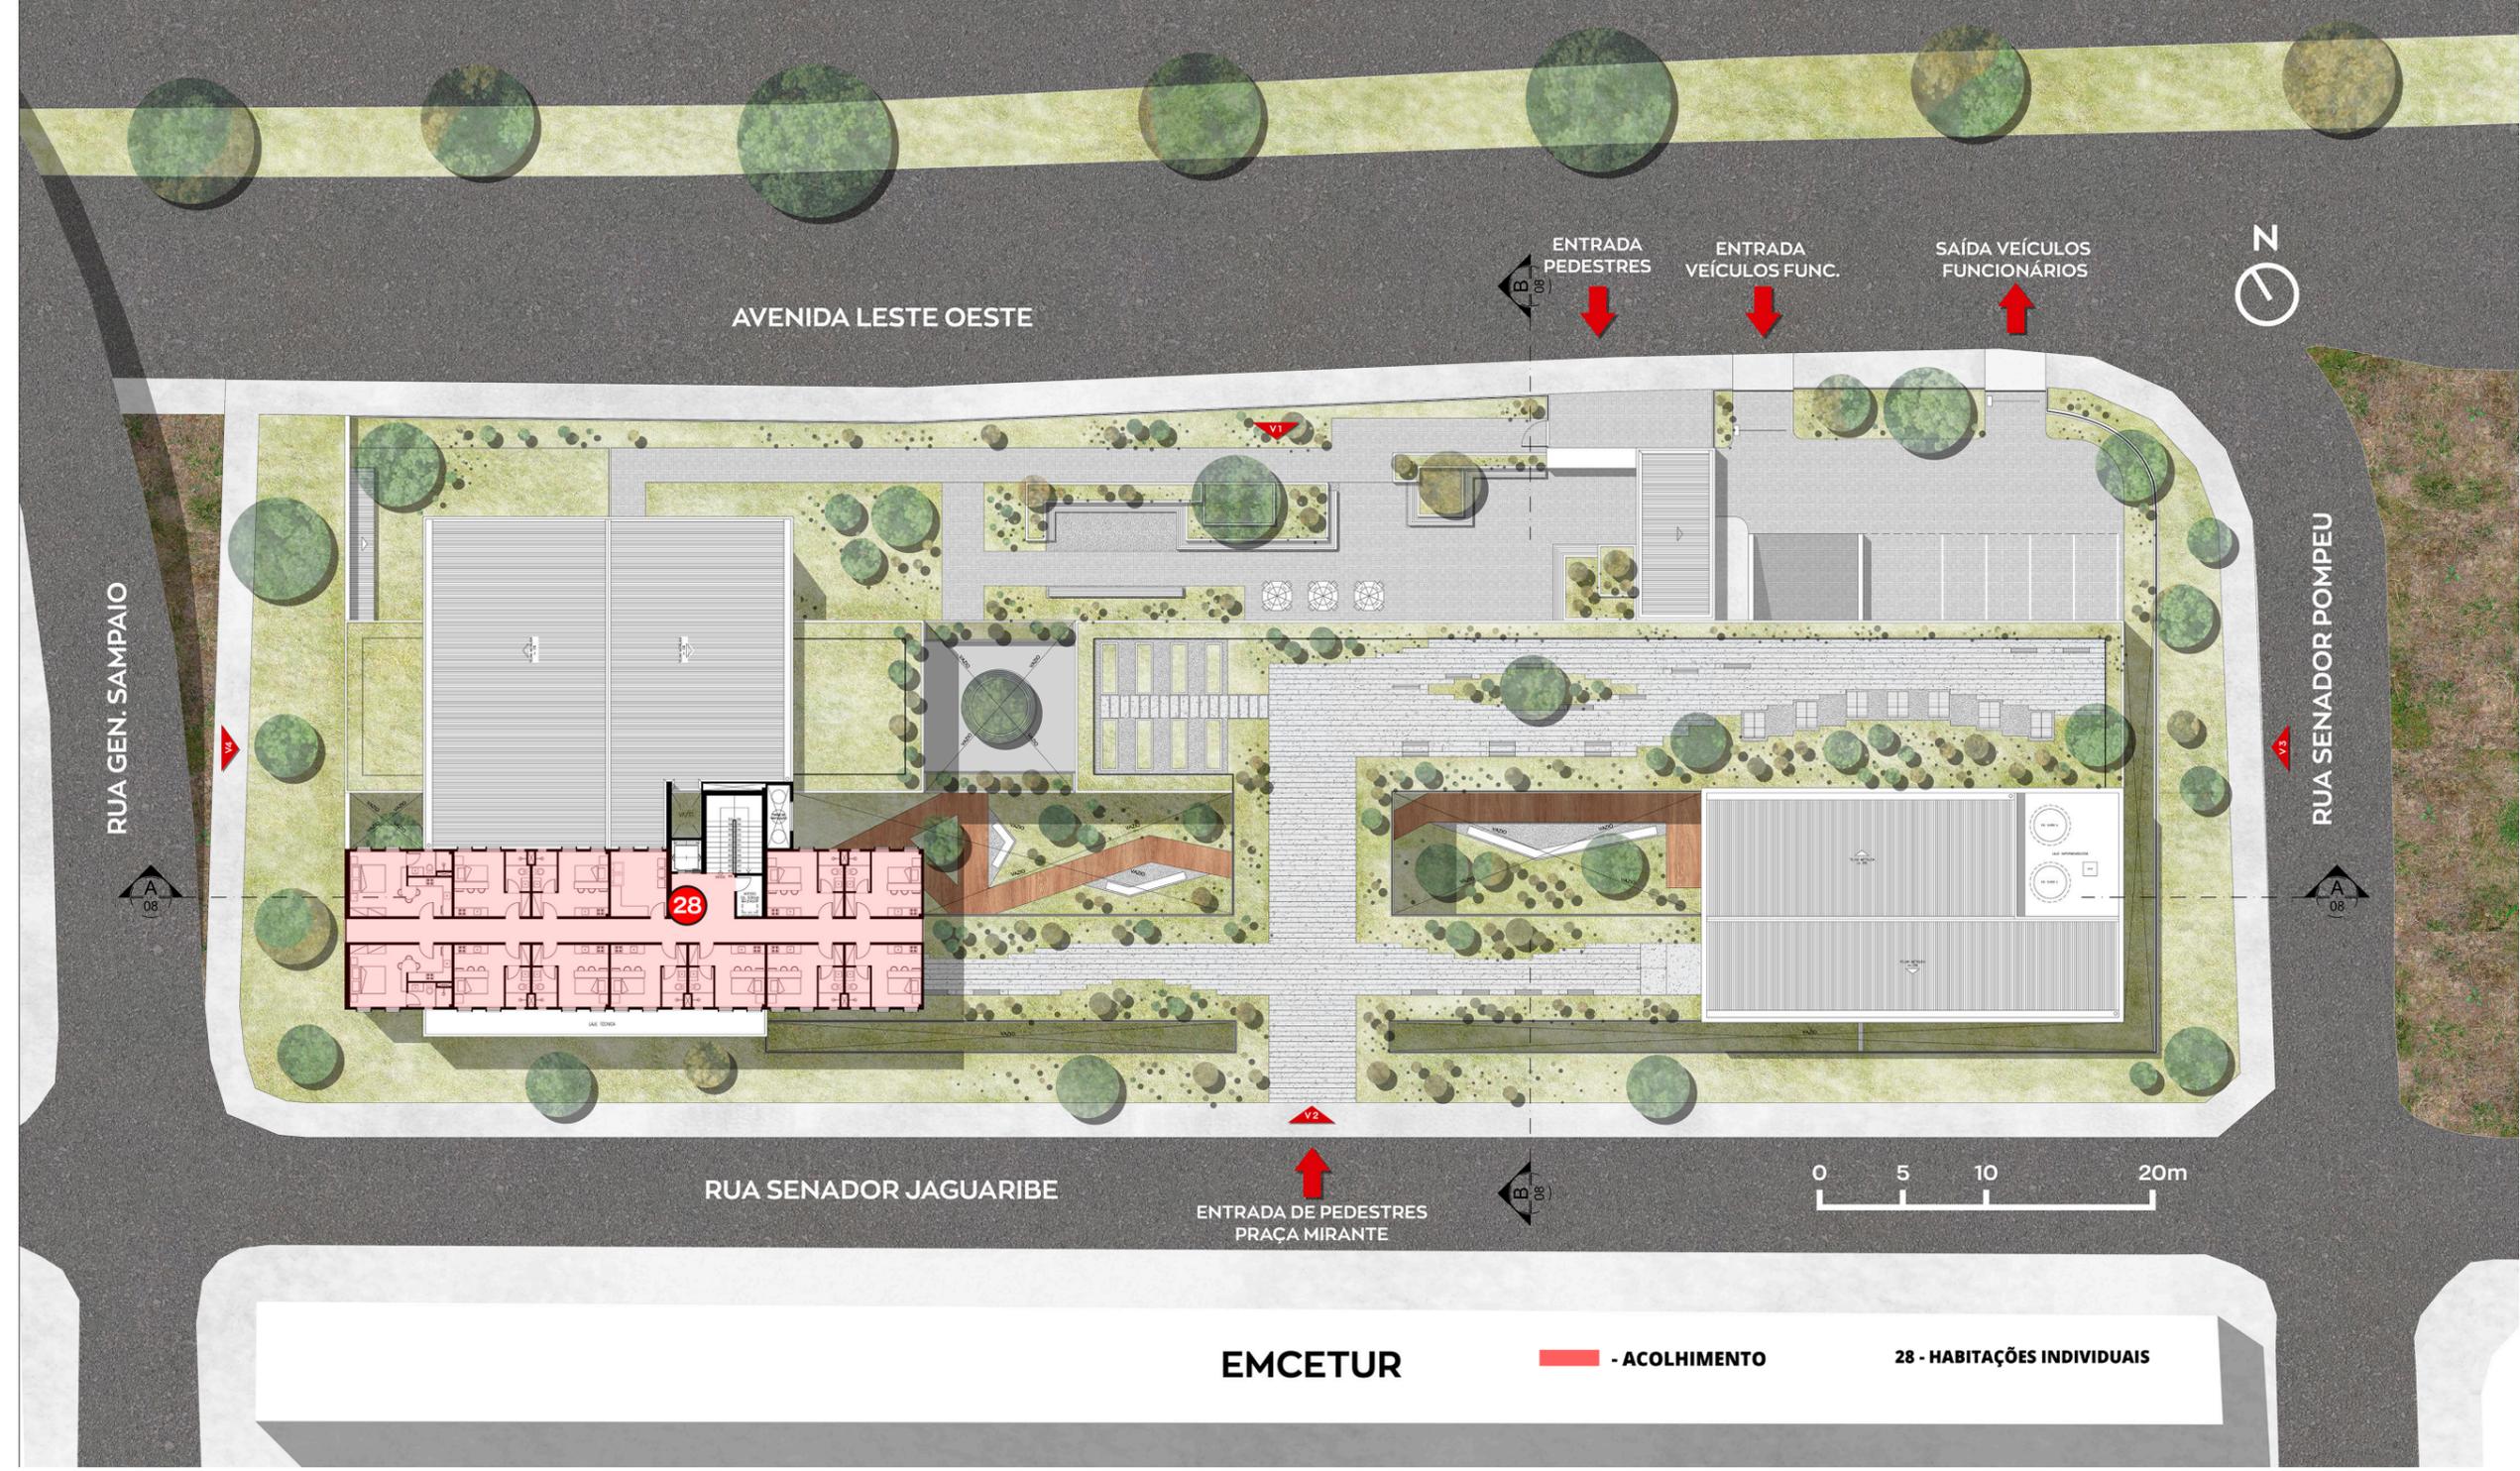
Planta baixa 3º Pavimento. Fonte: Autoral.
